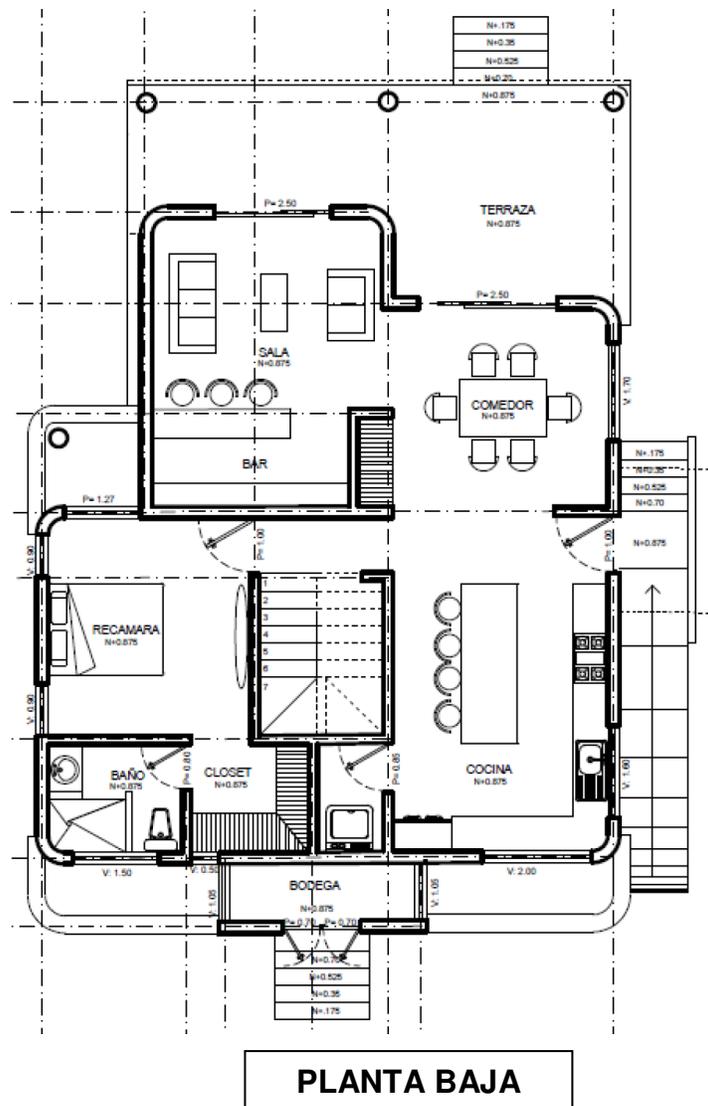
Planta de conjunto de la planta baja de la cabaña.
